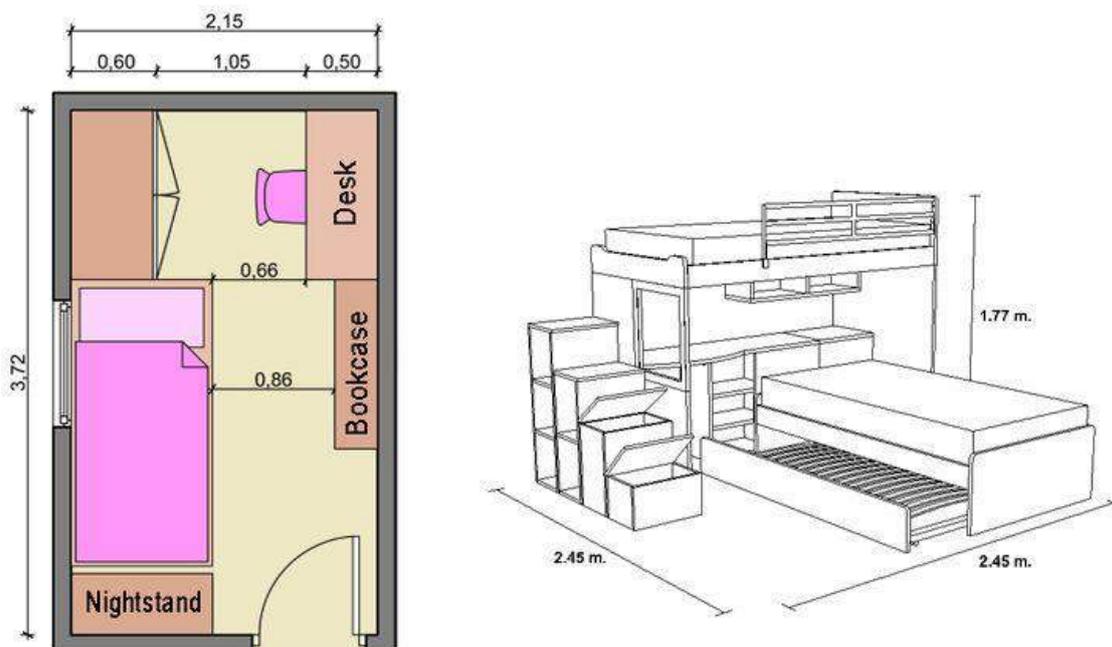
Alternativas de Distribución de un Dormitorio Secundario.
